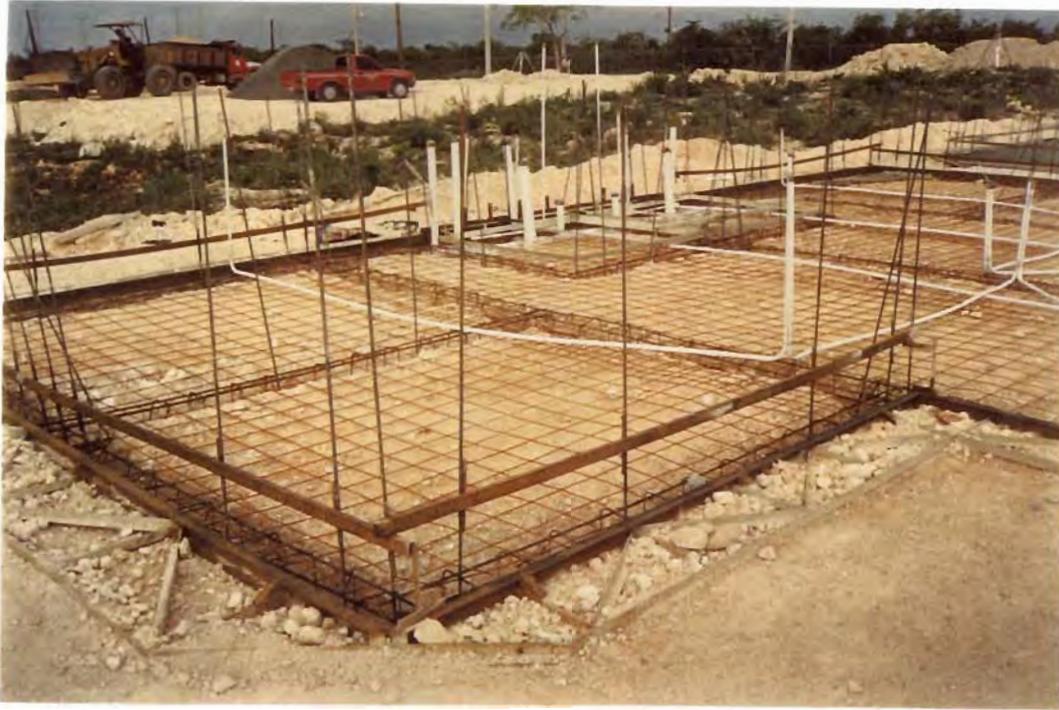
Losa de cimentación lista para fundir: Se puede apreciar la malla electrosoldada de refuerzo, las instalaciones sanitarias, hidráulicas y eléctricas y los bastones de refuerzo de los muros. Nótese que hay guías para la ubicación de los bastones.
